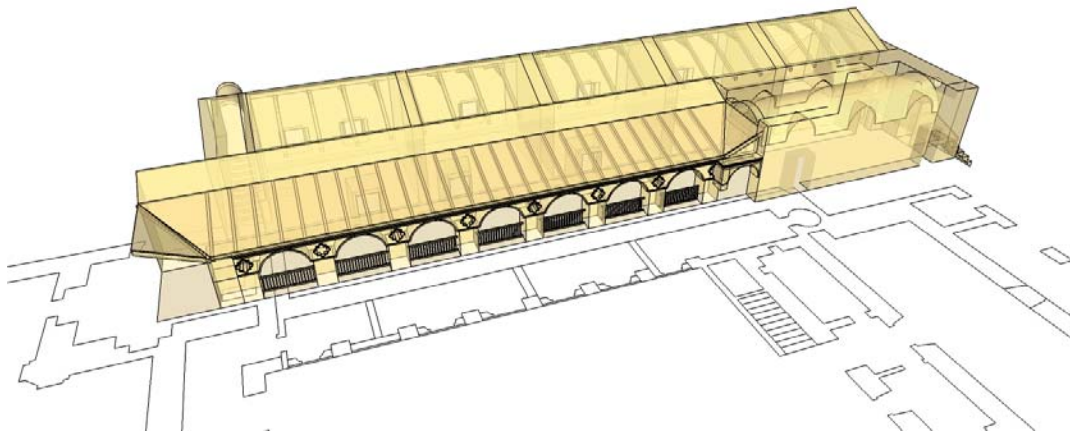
Reconstrucción Virtual Sector 2 b: Ala Oeste Planta Alta
